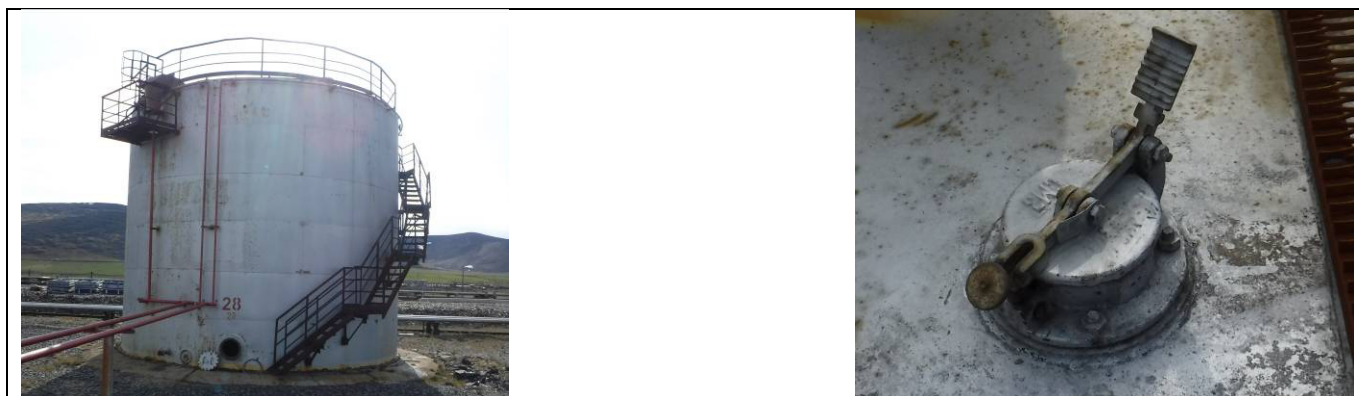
Общий вид резервуара РВС-700 (№28) с замерным люком
